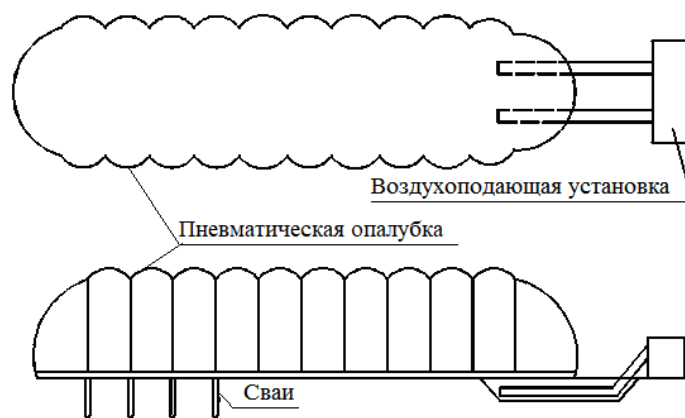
Схема монтажа пневматической опалубки и воздухоподающей установки
